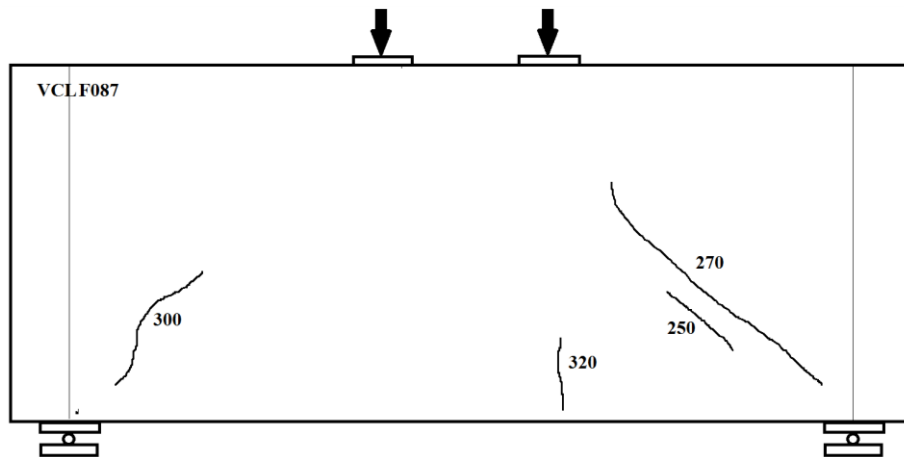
Esquema de fissuração da viga VCLF087.
